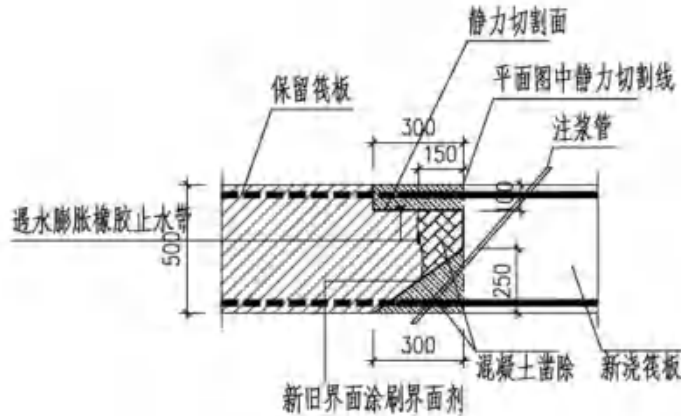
地下室新老混凝土结合部新型构造措施
